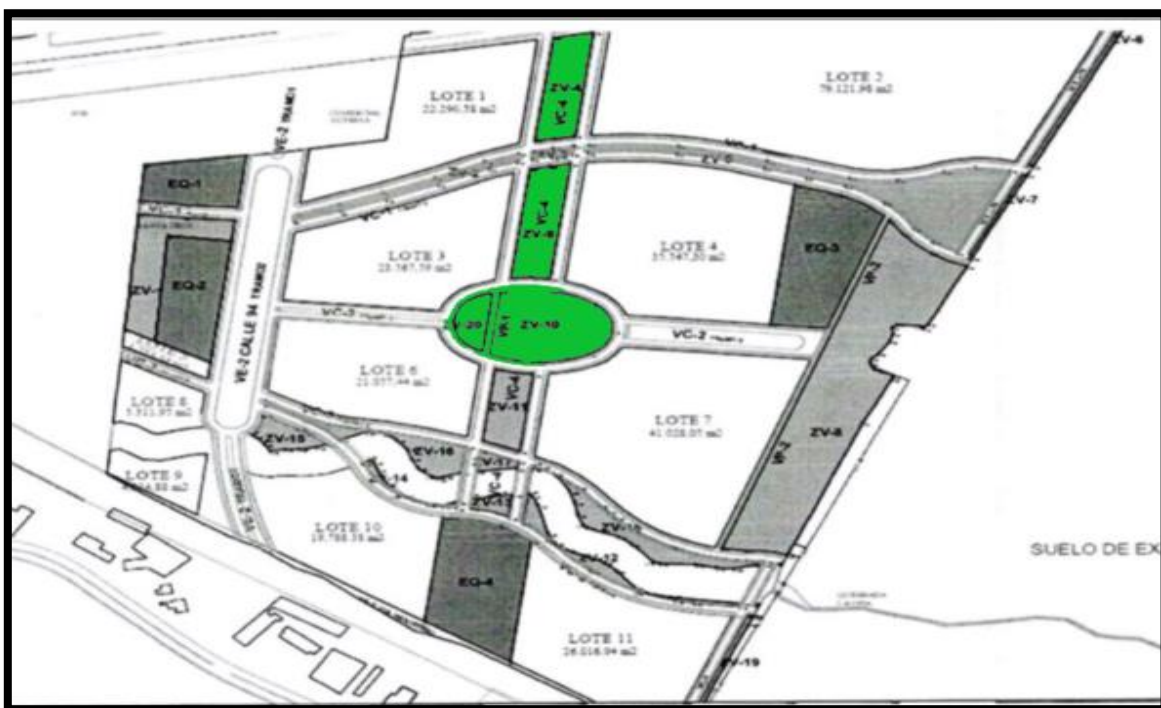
muestra las 3 zonas que actualmente se encuentran construidas de espacio público (parques lineales) en el plan parcial. Fuente: Alerta Tolima.
